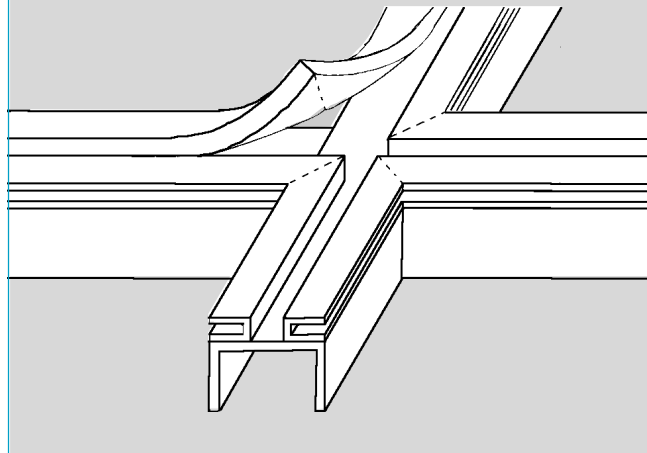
Joints d'étanchéité d'angle préfabriqués et joints droits assemblés par vulcanisation
